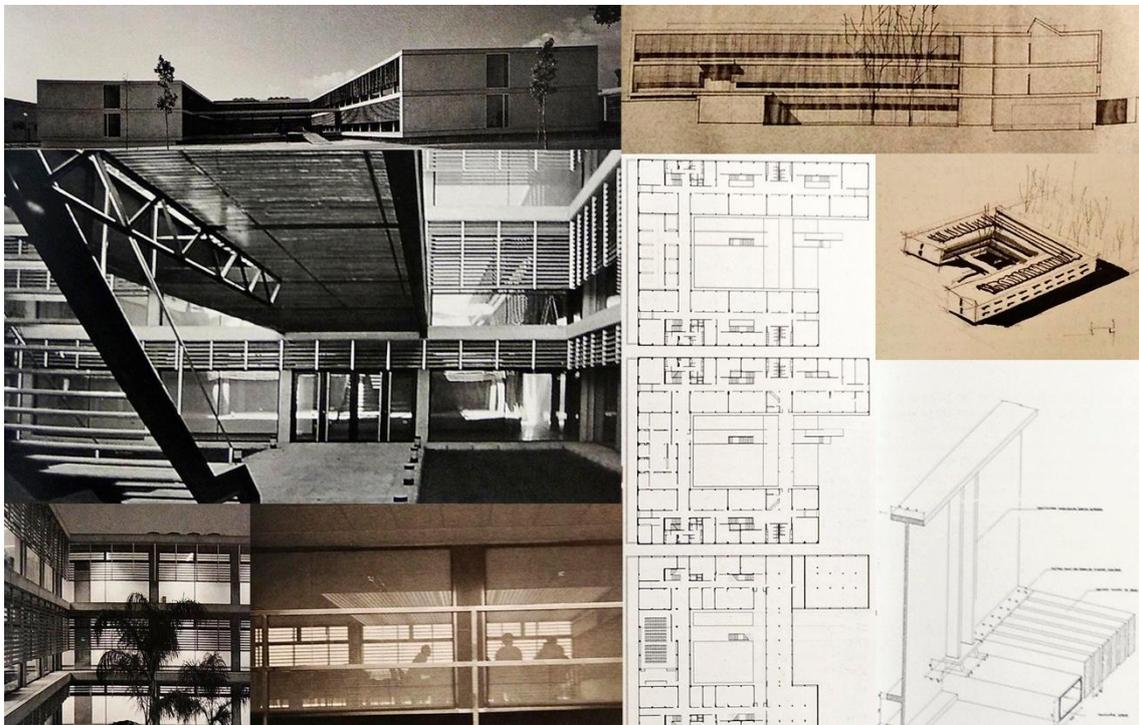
Vistas exteriores, vista carpintería interior, planos, croquis volumétrico y detalle constructivo.
